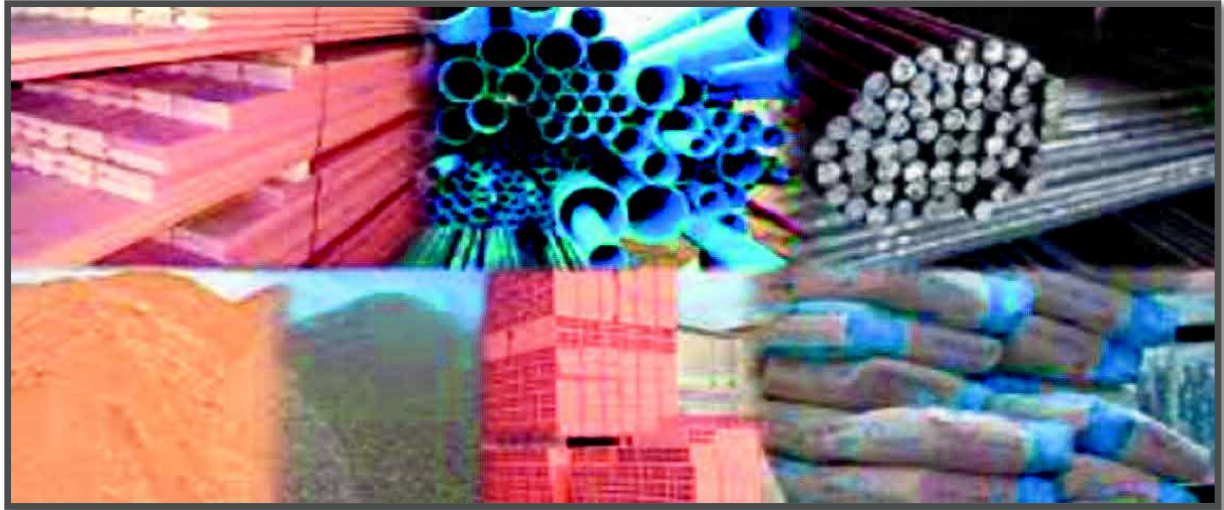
les choix des matériaux de construction ; Source : opmr.re
